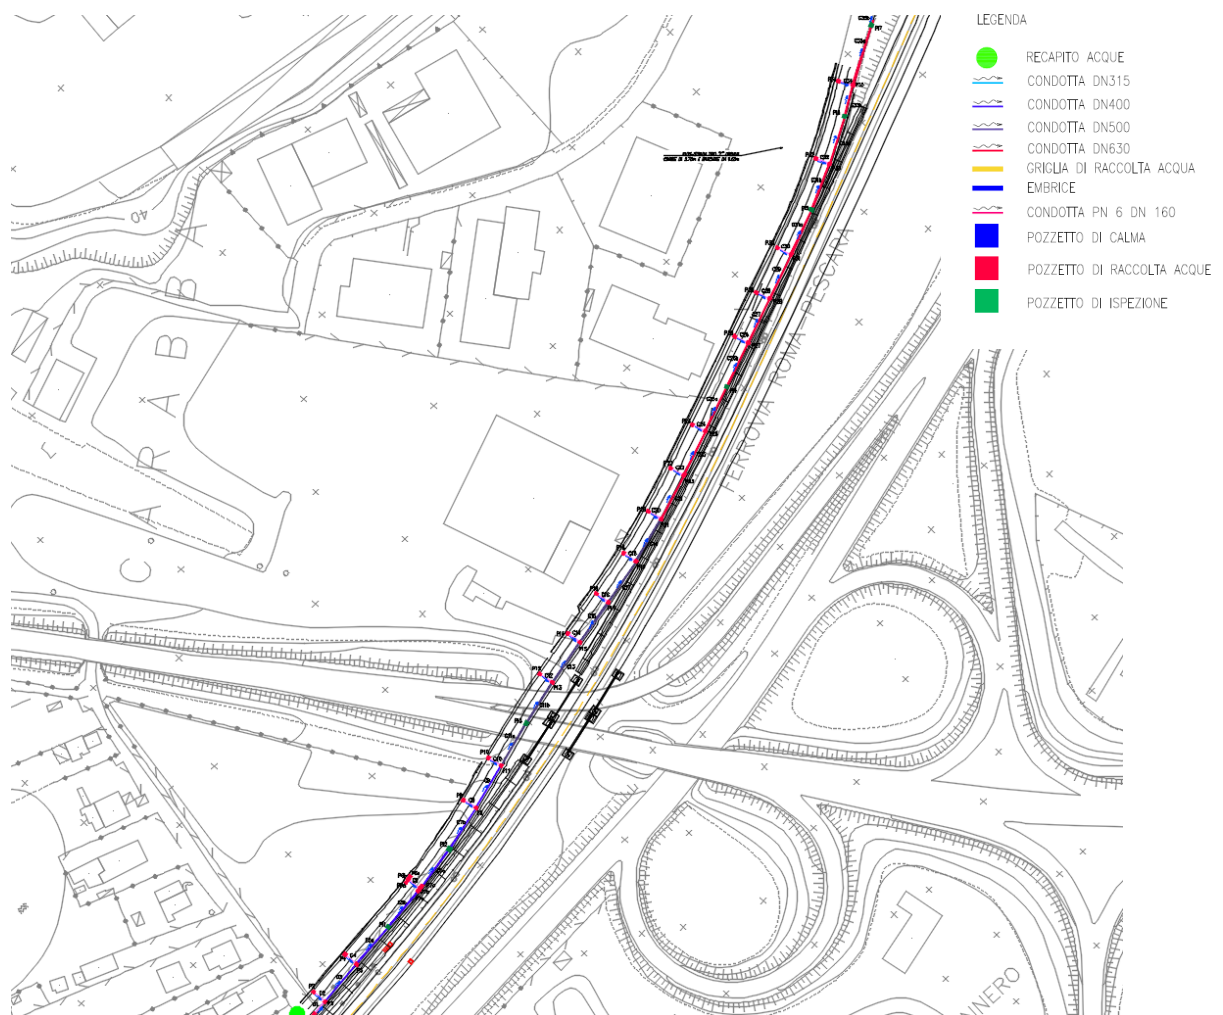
Stralcio planimetrico della rete di drenaggio Viabilità NV35
